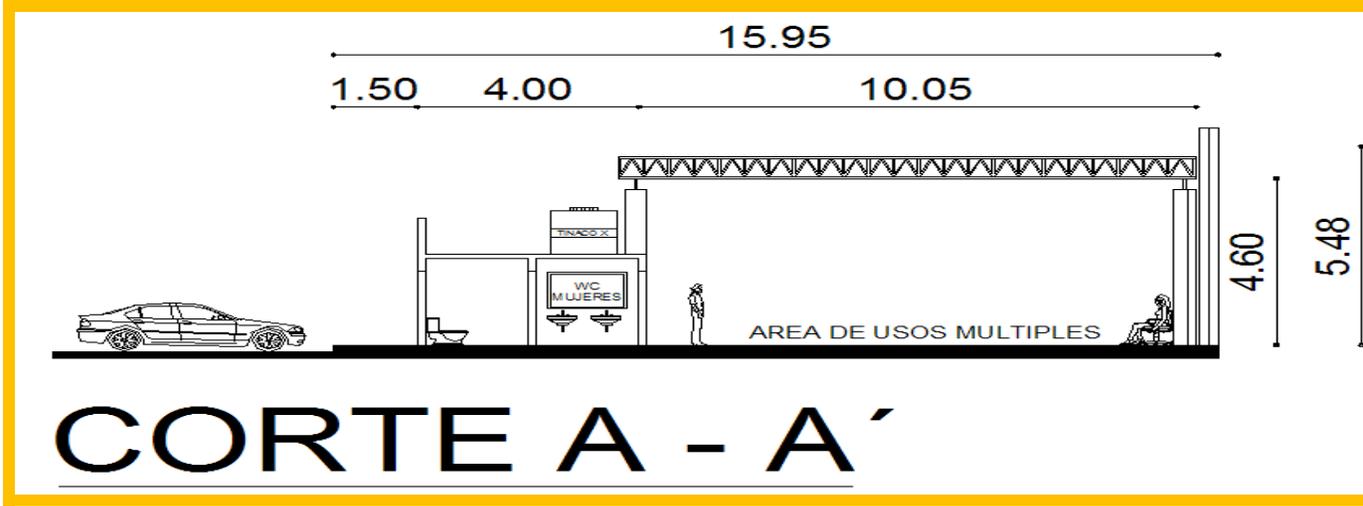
(corte A-A'-u.h. Emiliano Zapata)
